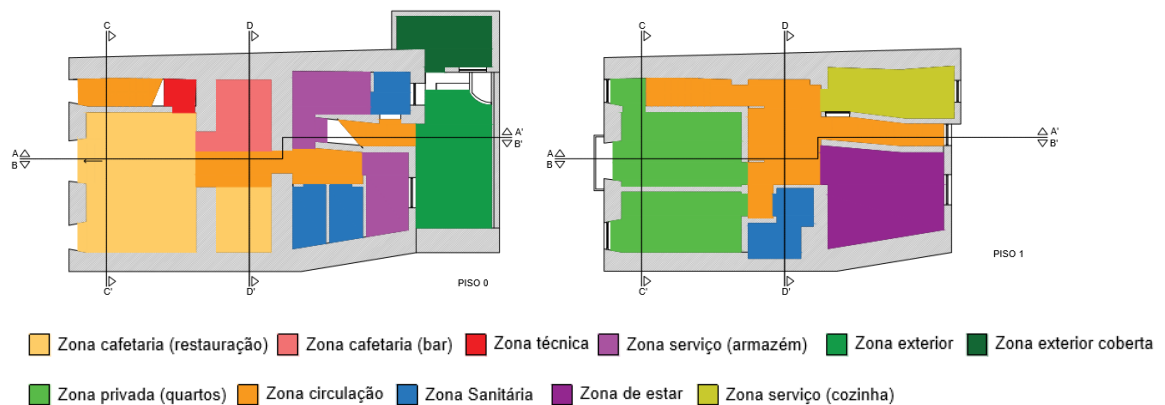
Planta de zonamentos, piso 0 e piso 1.
